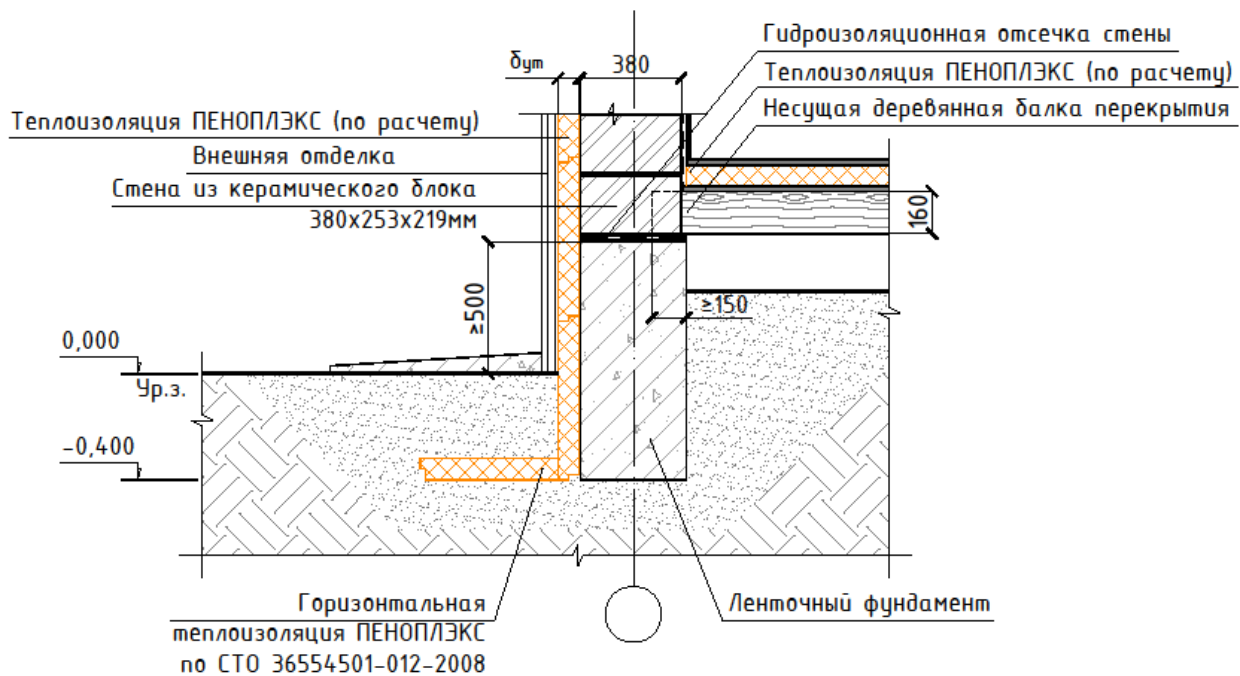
Схема сопряжения малозаглубленного ленточного фундамента и стены из керамических блоков.
